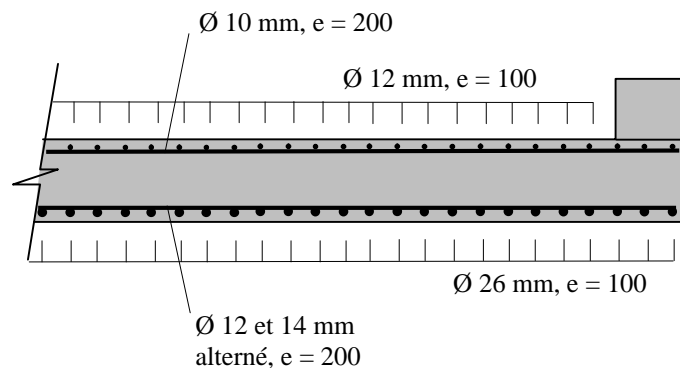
Coupe transversale du bord de la dalle du pont N°10.
